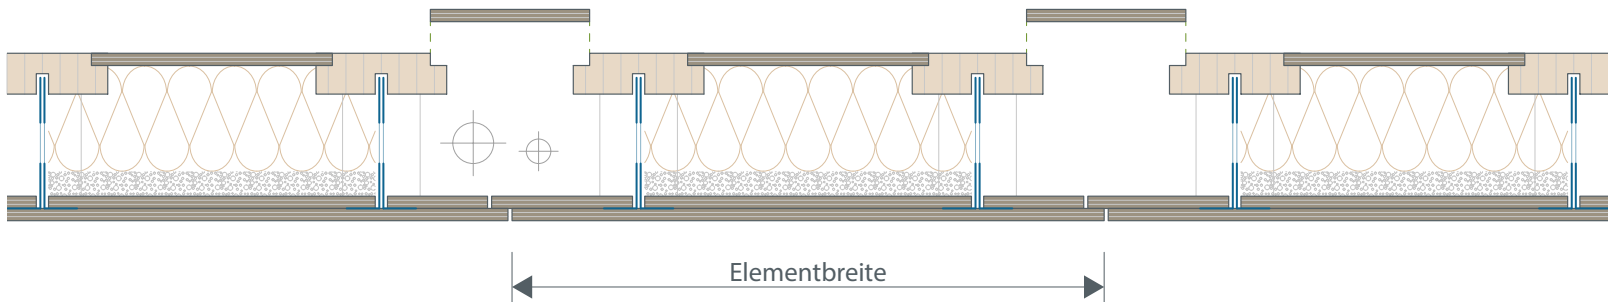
Entwurfsansatz 02 - Hohlkastendecke aus LVL-Beplankungen und BSH- Stahl Verbundrippen (Vertikalschnitt in Feldmitte)
